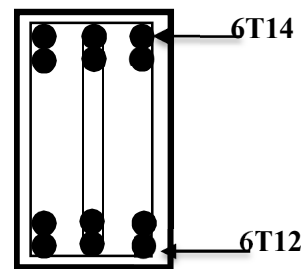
Dessin de ferrailage des sections des poutres principales
